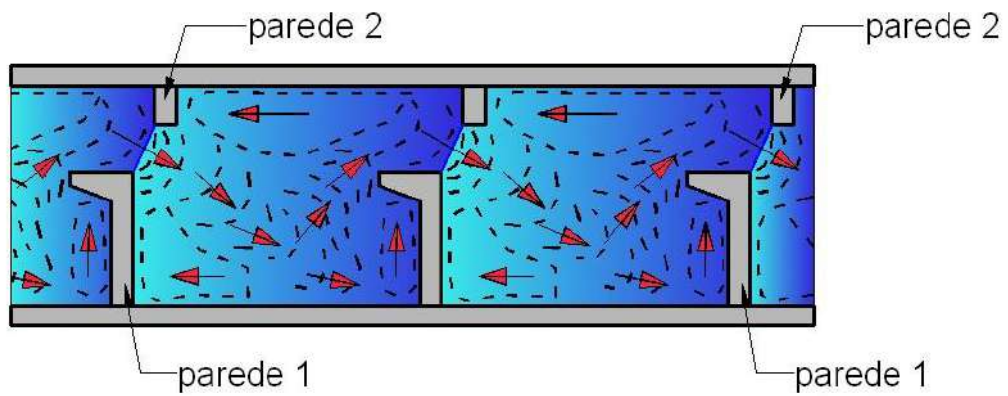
Planta e linhas de fluxo (Vertical Slot).
